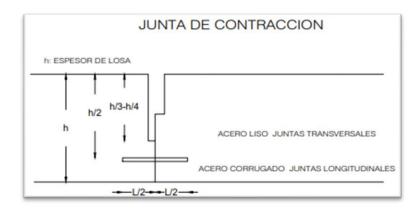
Ilustración del corte de la junta de contracción Fuente: Elaboración compañía GESCO S.A.S
